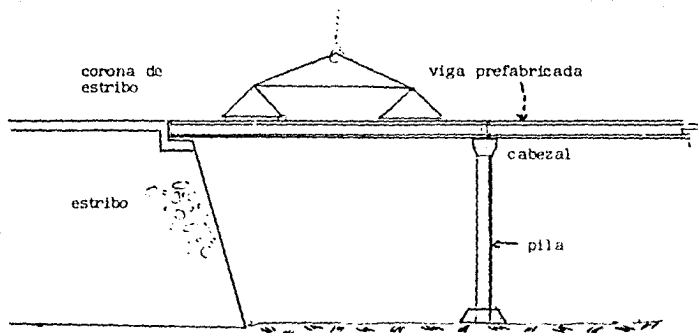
PUENTE CON VIGAS PREFABRICADAS
